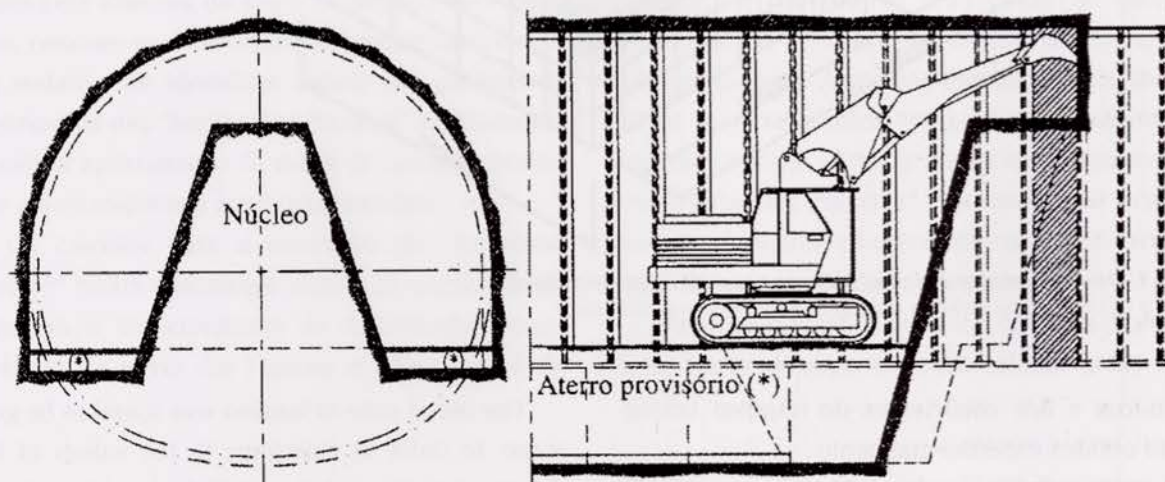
Túnel do término - sequência de escavação e de colocação da estrutura de suporte
